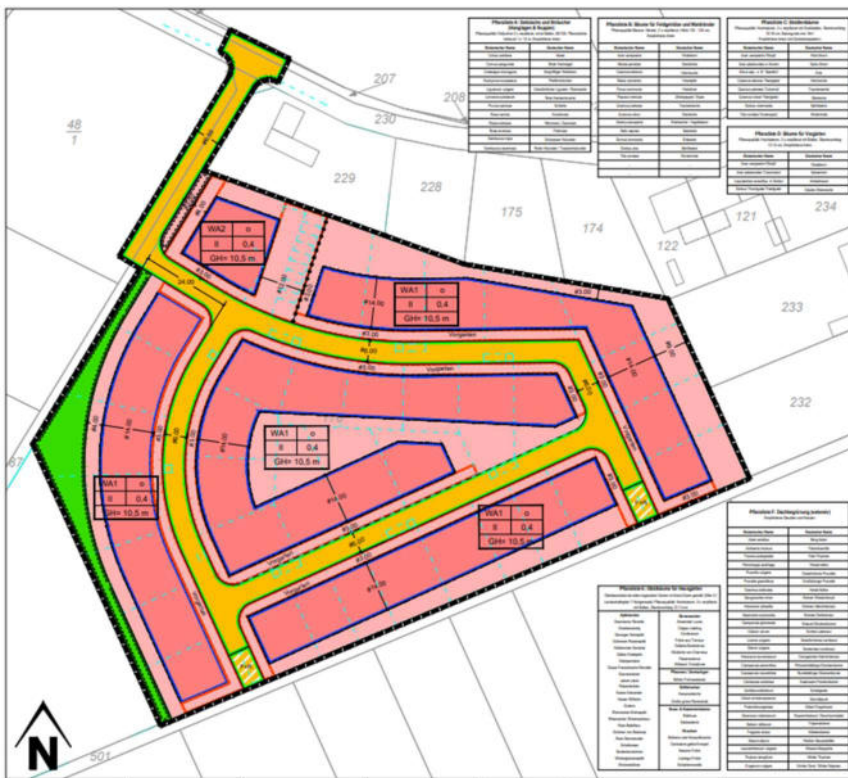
Planurkunde des Bebauungsplans als Entwurf
